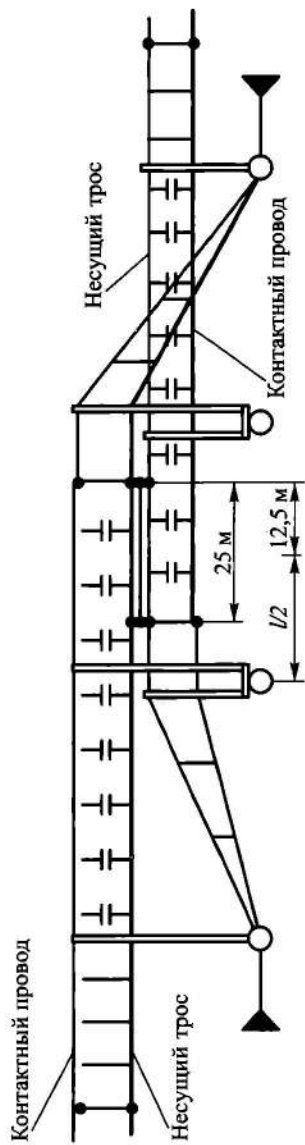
Схема размещения электрических соединителей на неизолирующем сопряжении анкерных участков при плавке гололеда
